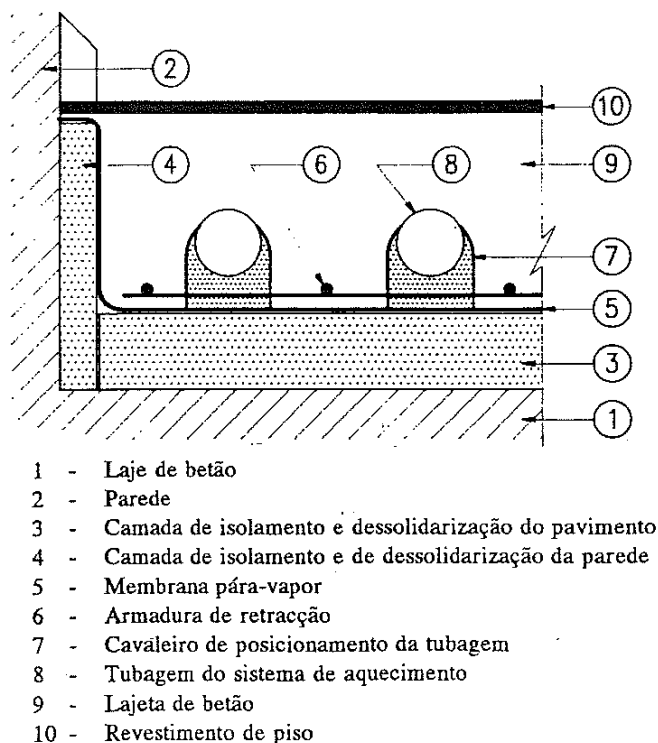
Esquema de montagem da tubagem sobre a armadura de retracção em pavimentos com camada dessolidarizada [10]
